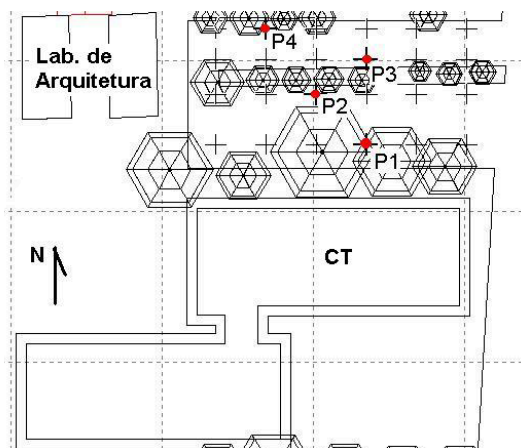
Modelo em planta do estacionamento analisado e localização dos pontos escolhidos para simulação.
